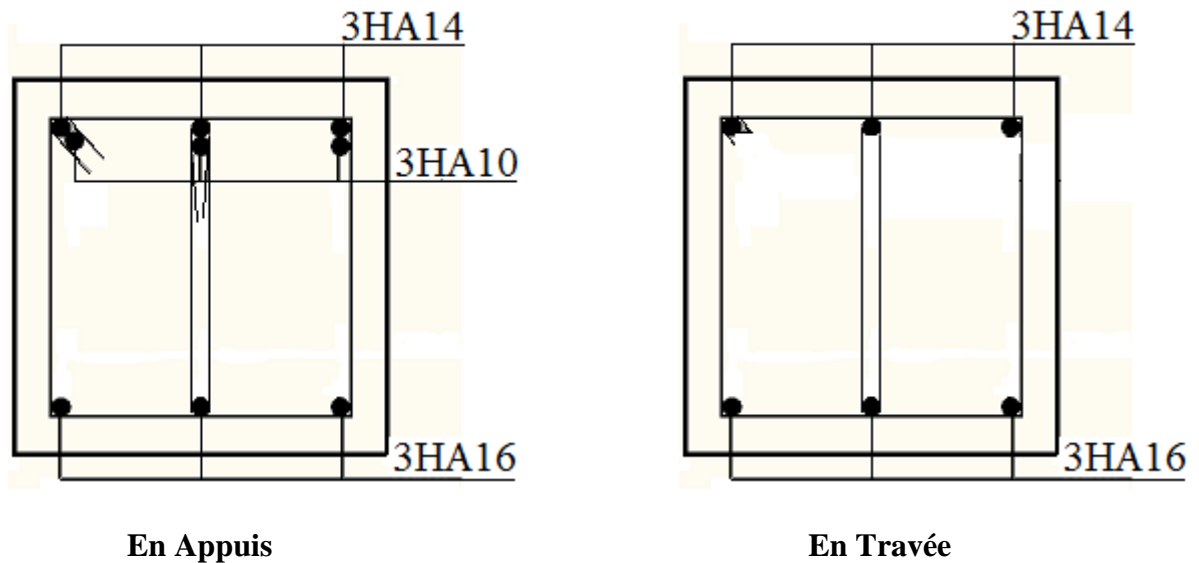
Schéma de ferrailage de la poutre palière.
